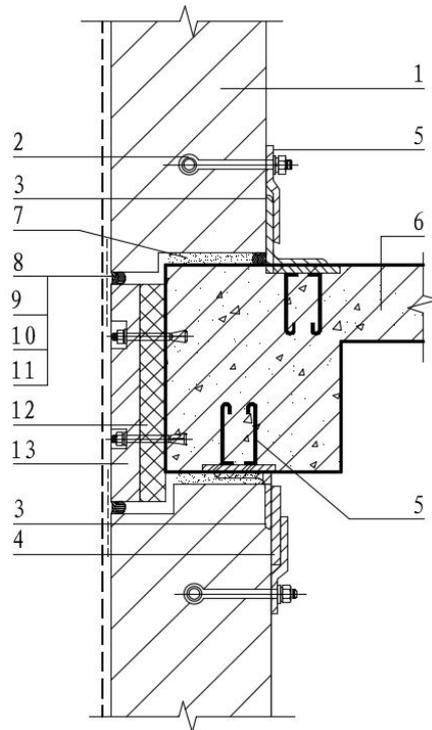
轻混凝土外墙板与主体结构螺栓连接构造示意图
